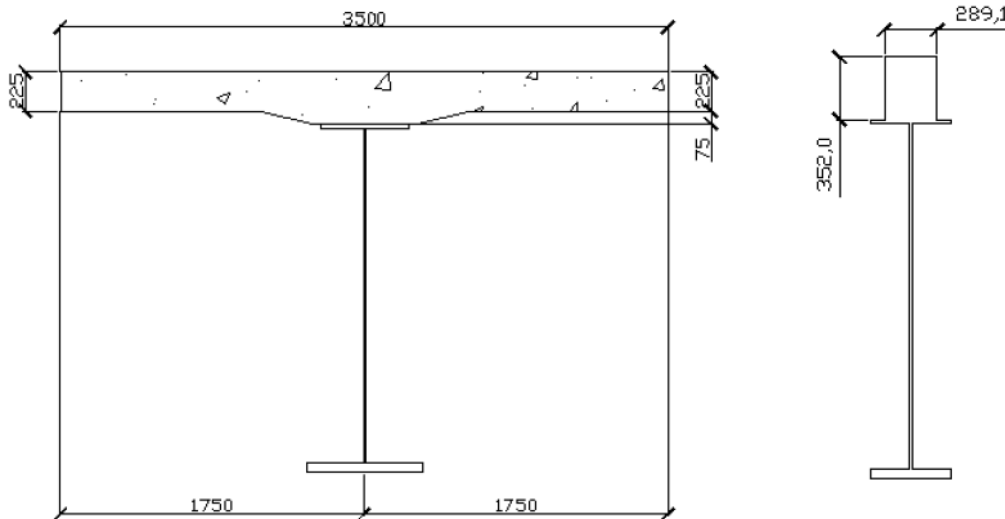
Seção das vigas mistas internas (no vão e no apoio) e seção equivalente de aço (adaptado de TOLEDO, 2010). Dimensões em mm.
